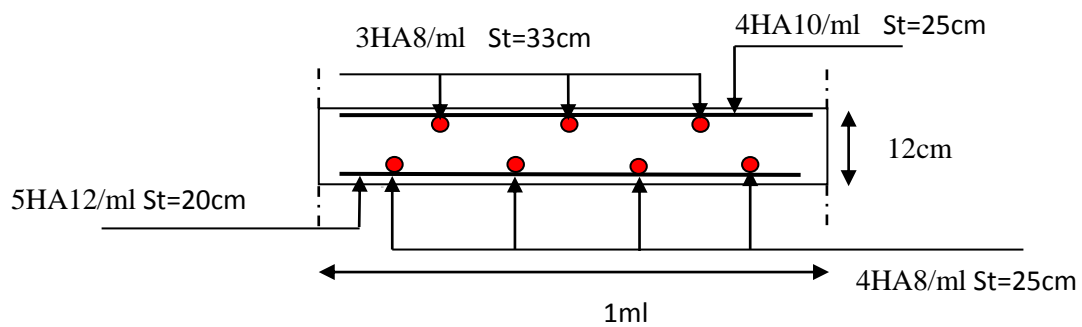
Schéma de ferrailage de la dalle pleine type N° 3.
